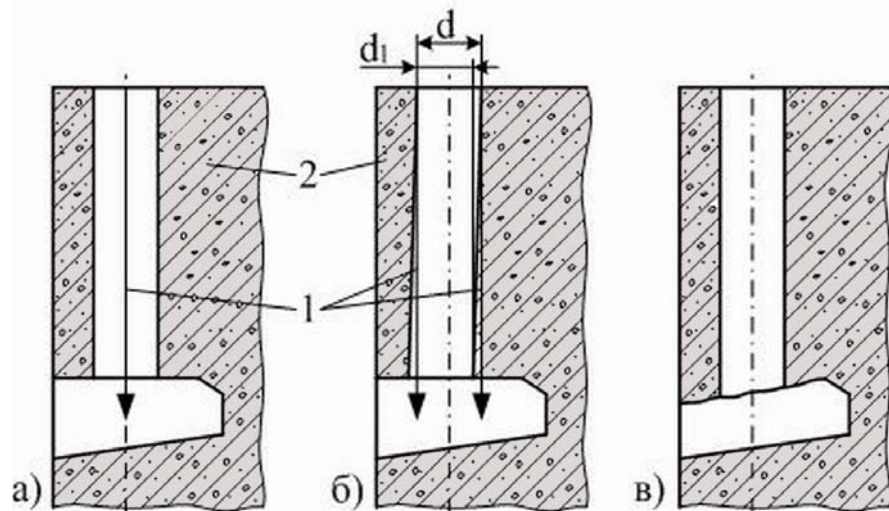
Колодязі під анкерні болти: а) правильне виконання; б) *вісь (axis)* анкерного колодязя перекошена; в) поверхня прилягання нижньої анкерної плити нерівна; 1 – підвішений вантаж; 2 – фундамент
